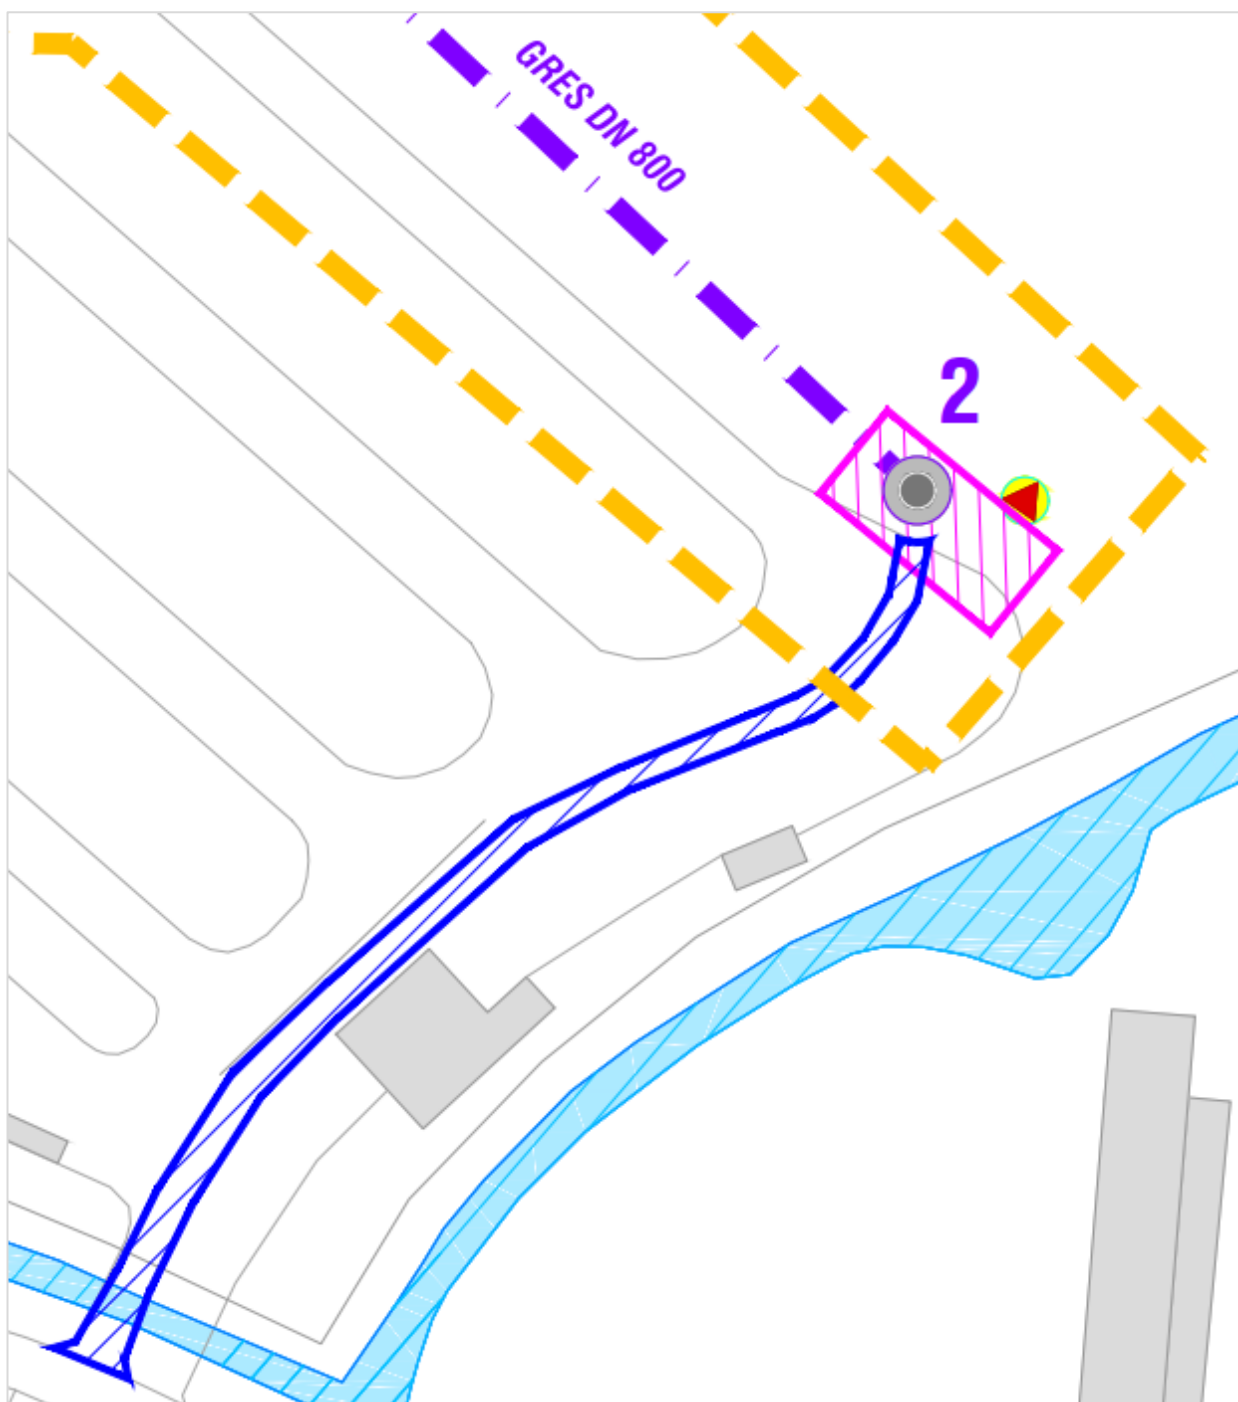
O : Inquadramento planimetrico area cantiere pozzo S2
